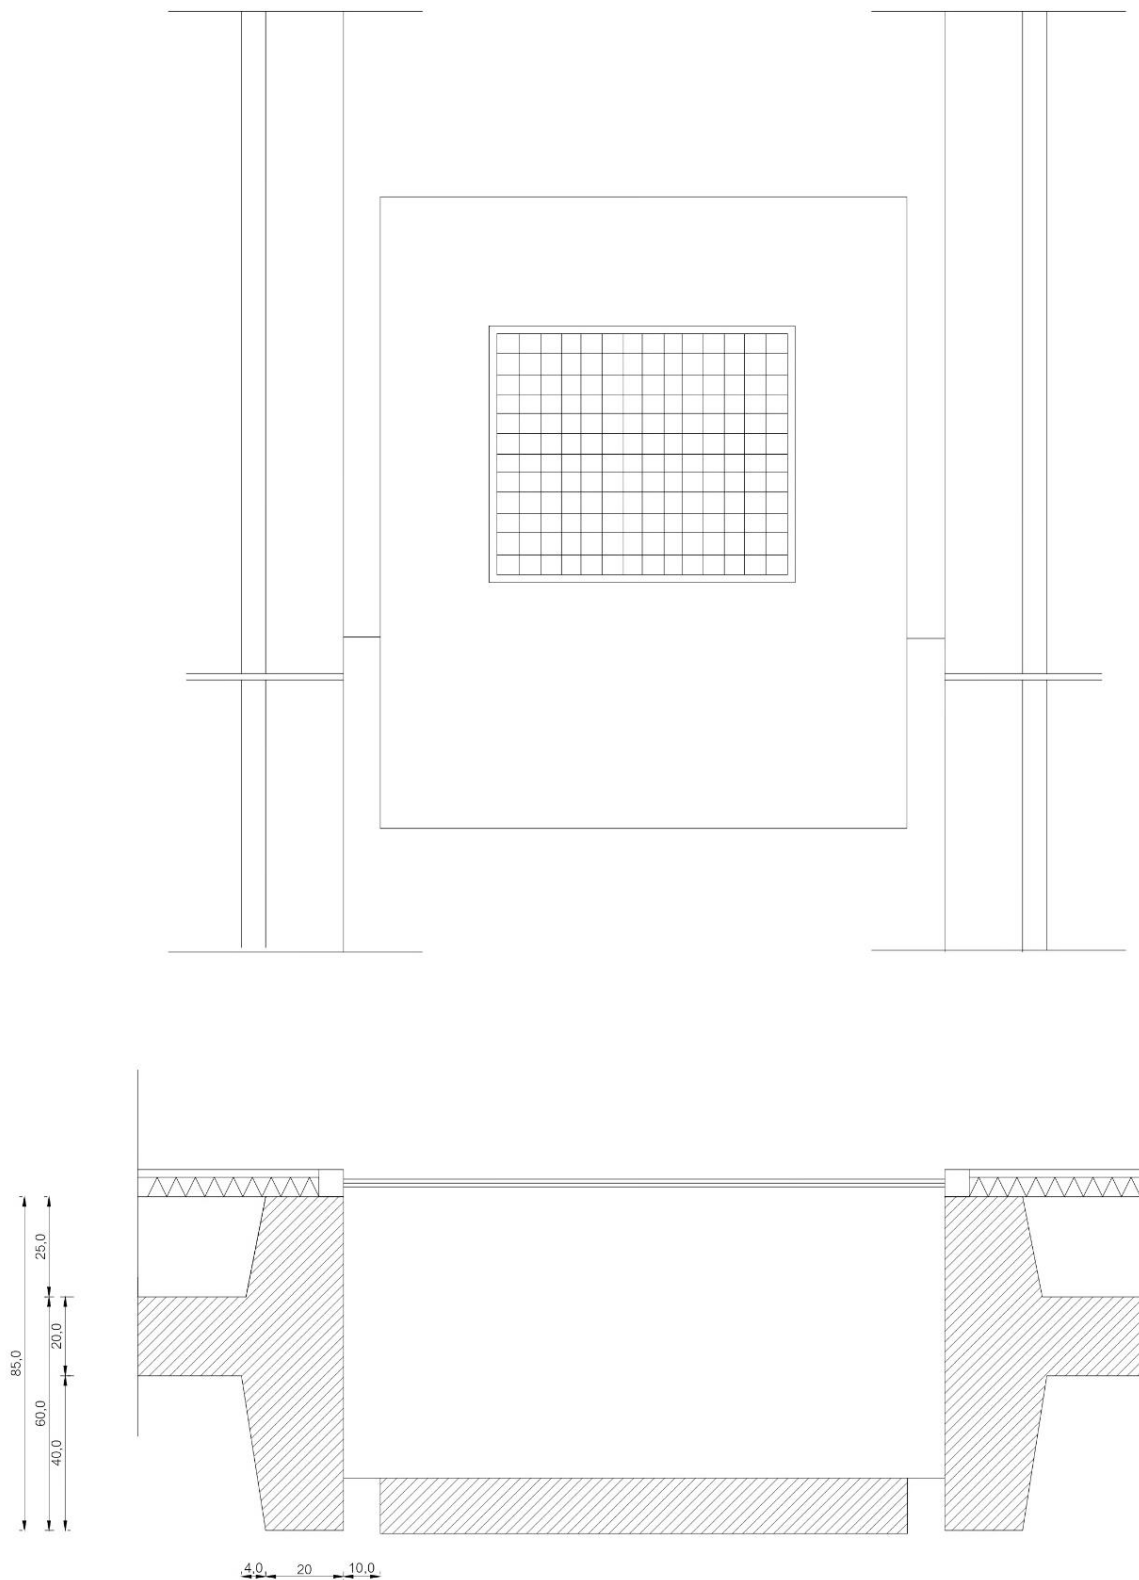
Détail en élévation et en plan du balcon de la tour Match
